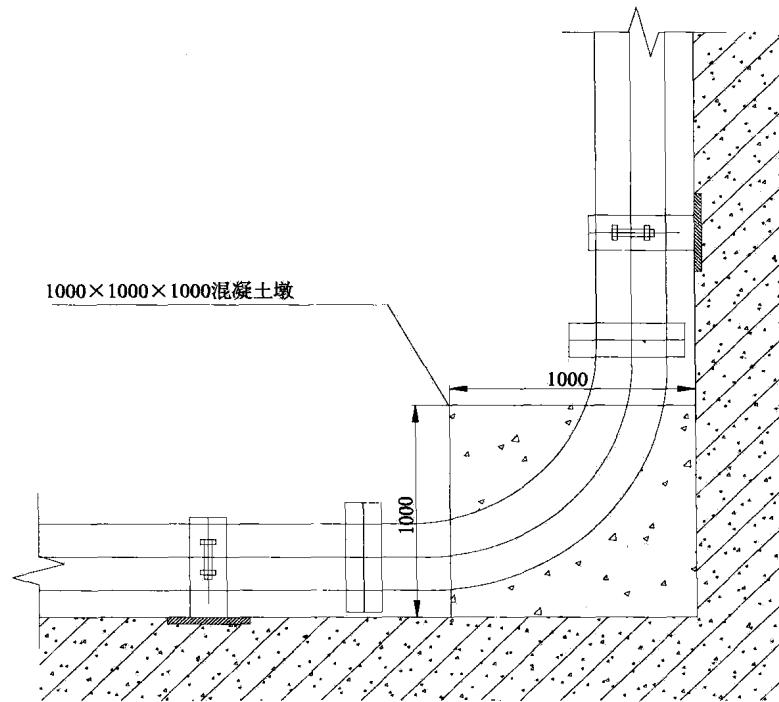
一层泵管水平与竖向相交处混凝土墩详图
